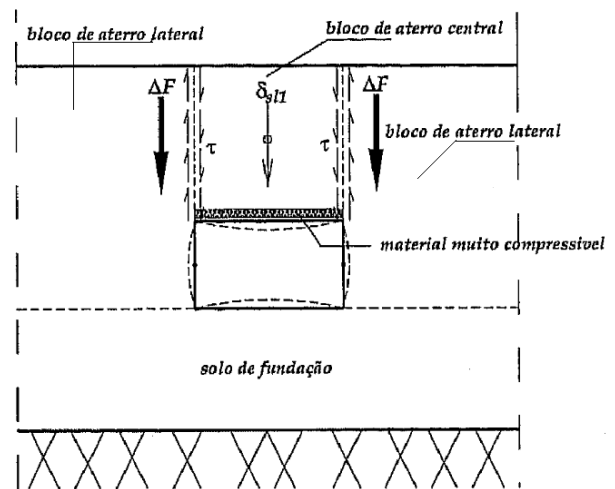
Redistribuição de cargas para os aterros laterais com recurso à colocação de material muito compressível sobre a travessa da *box culvert* (Sang, 2000)
